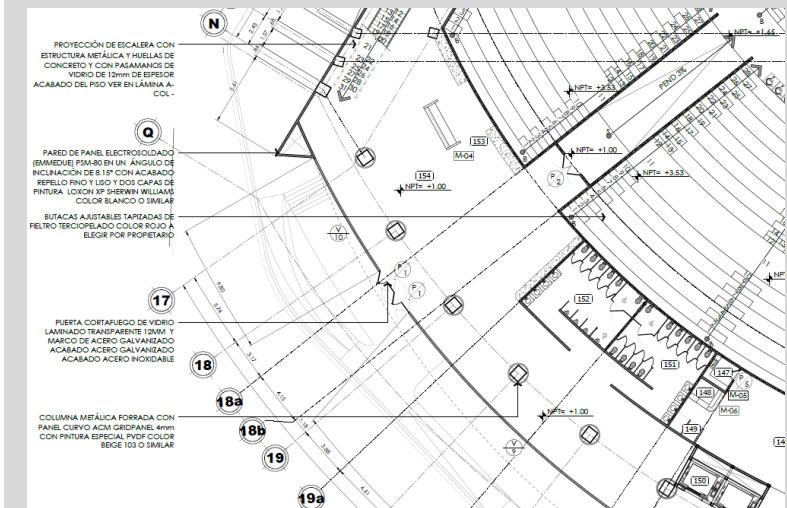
Segmento de planta arquitectónica de edificio Coliseo. Ver en anexo N° 15.
